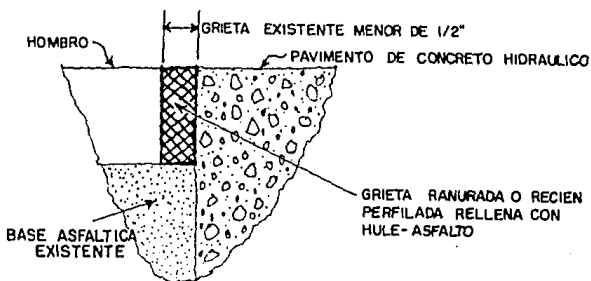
JUNTA CON UN ANCHO MENOR DE 1/2"
